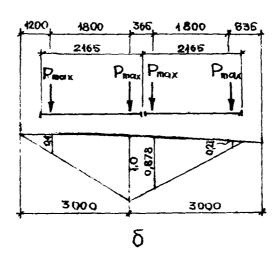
К примеру расчета фермы-пиафрагмы а-геометрическая основа: 6-линия влияния давления на днафрагму и установка нагрузки в невыгодное положение
